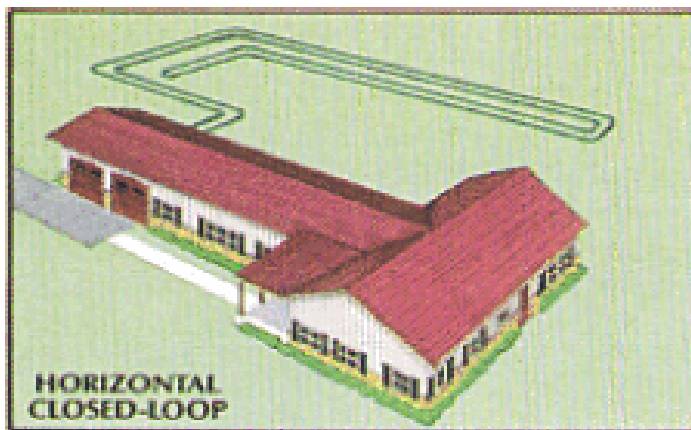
Arranjo do sistema GSHP fechado horizontal (NEW-98)
